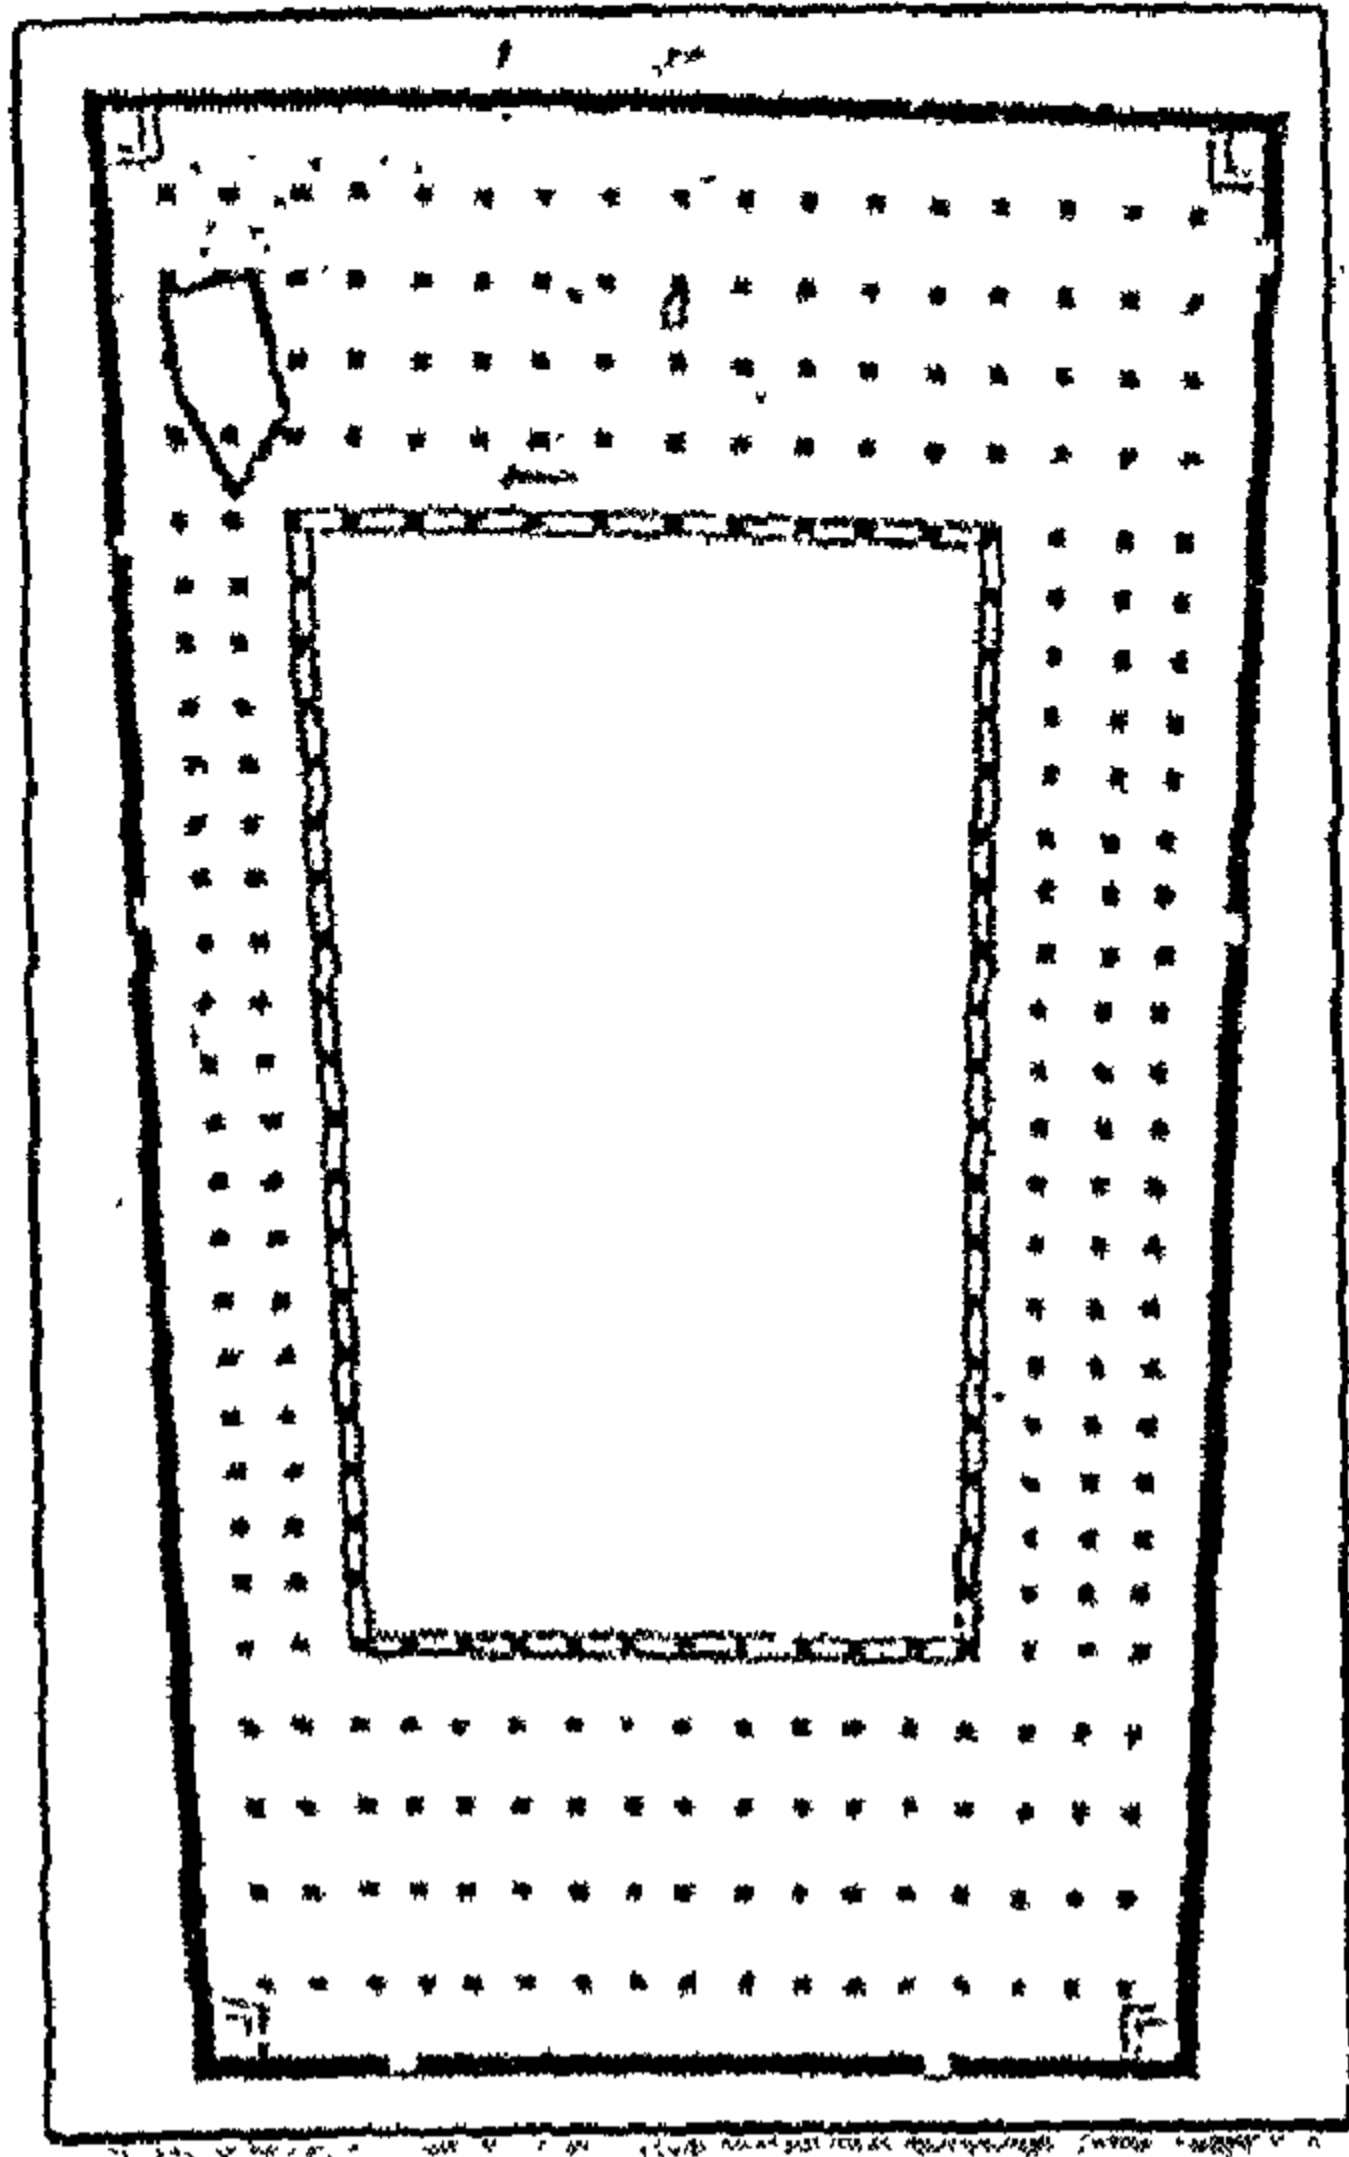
الجامع الأموي بدمشق (مسقط أفقي)
